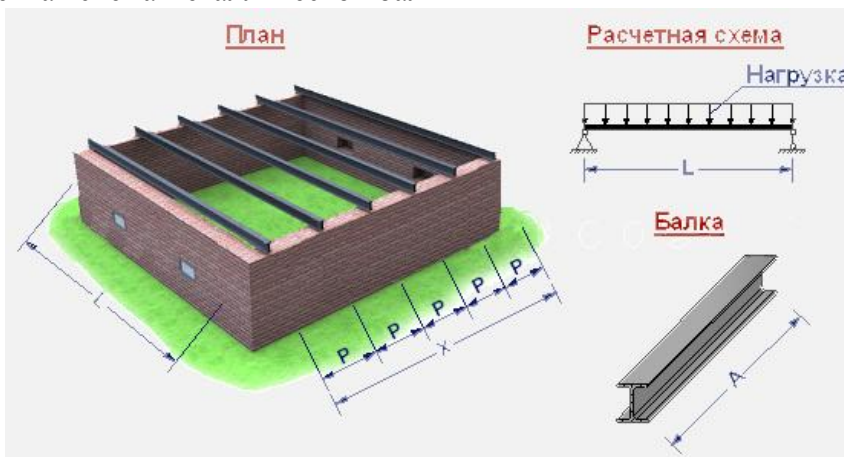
Вид сверху расстановки металлической балки на несущую стену
